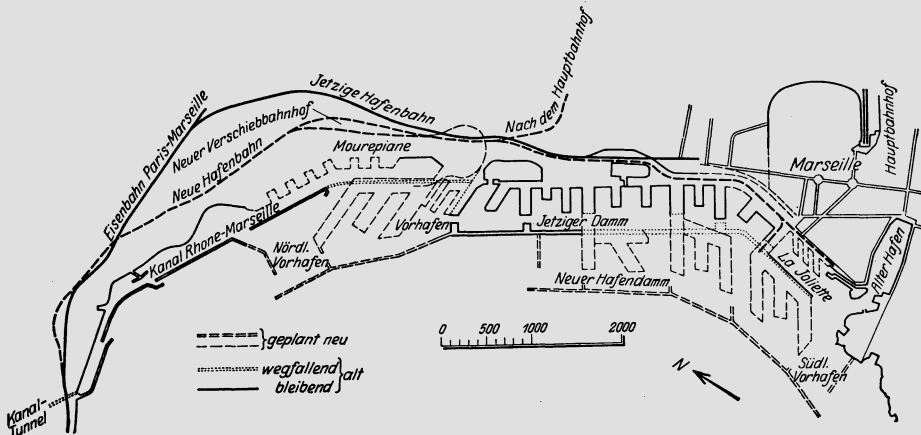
Übersichtsplan des Hafens von Marseille mit geplanten Erweiterungen. Offener Seehafen. Maßstab 1 : 83 500.
